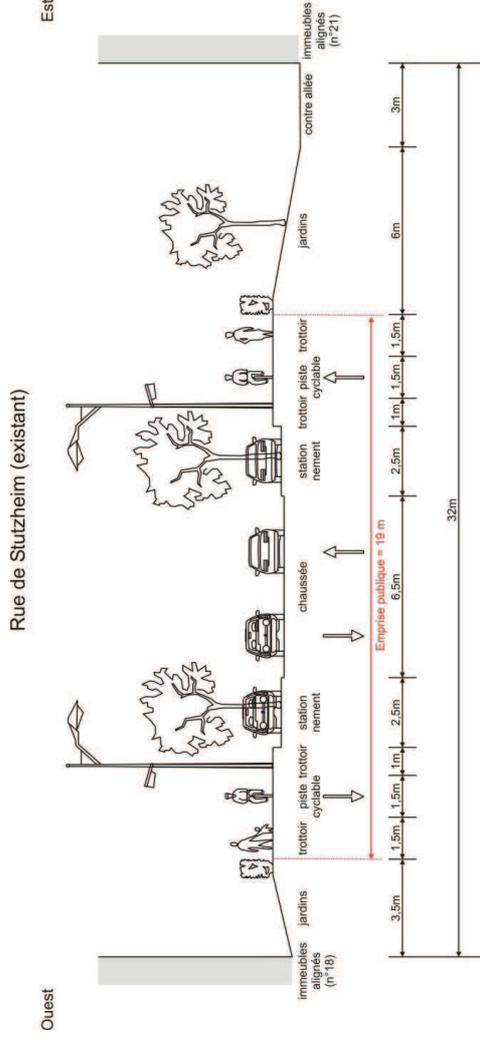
Situation existante coupe 5 sur la rue de Stutzheim
